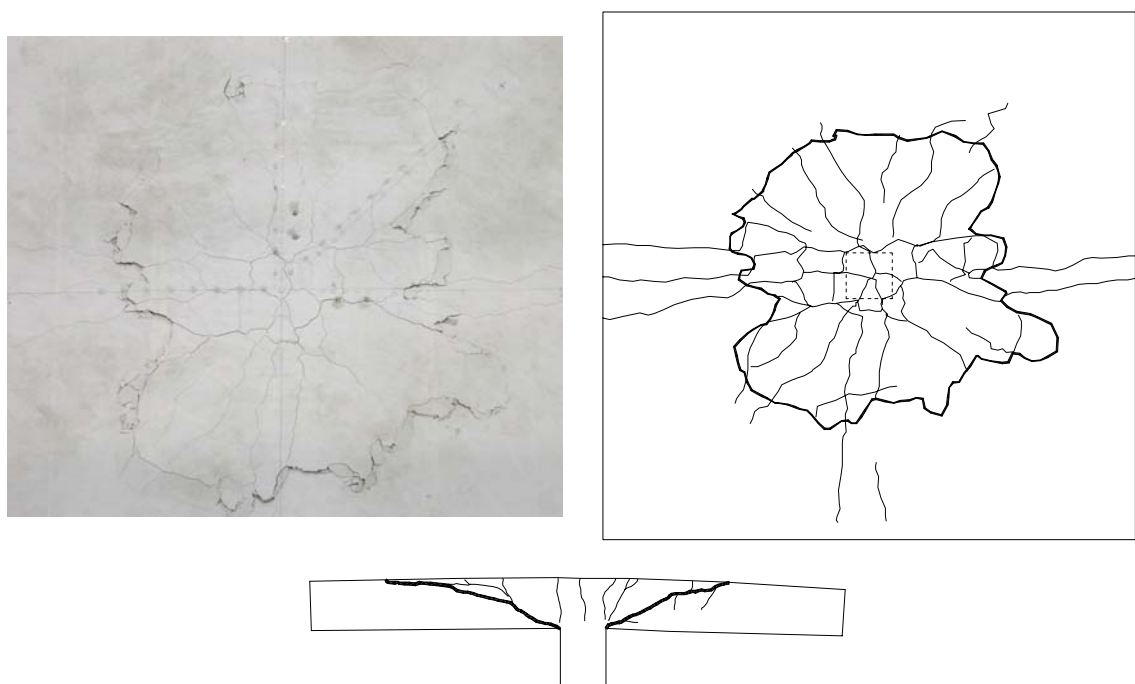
PG-5 : Fissures face supérieure (N en haut) et coupe NS
